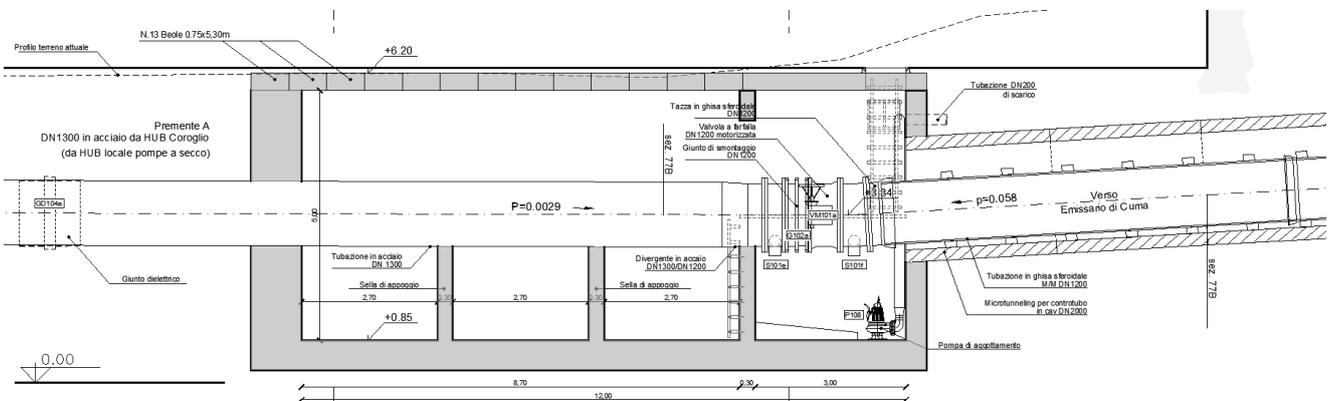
Microtunnel – Camera di spinta: Sezione longitudinale
